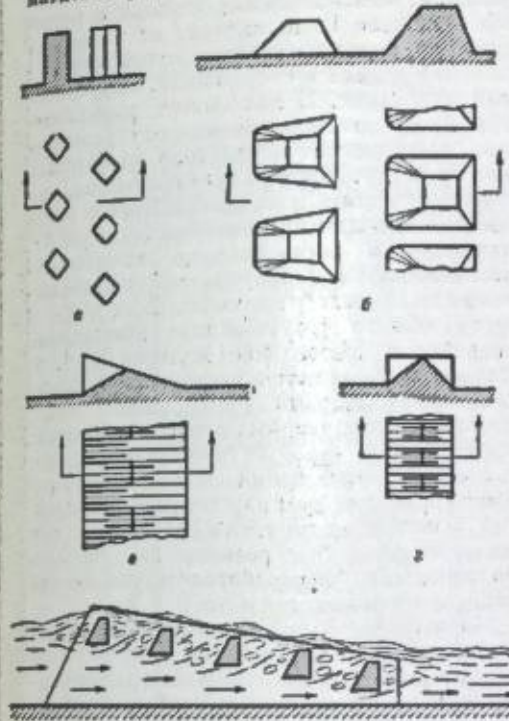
Гасители шашечные: а — столбчатые; б — пирамидальные; в и г — зубчатые пороги; д — балочный гаситель.
